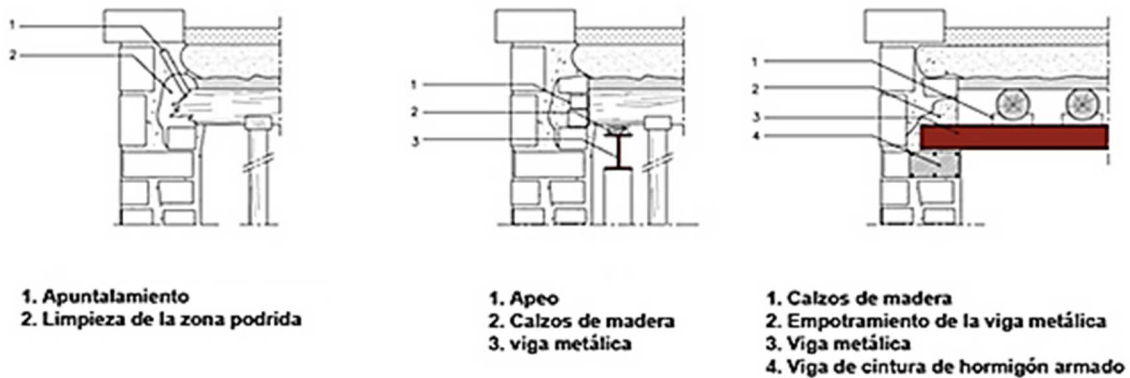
Reparación forjado mediante viga de borde empotrada en el muro.
